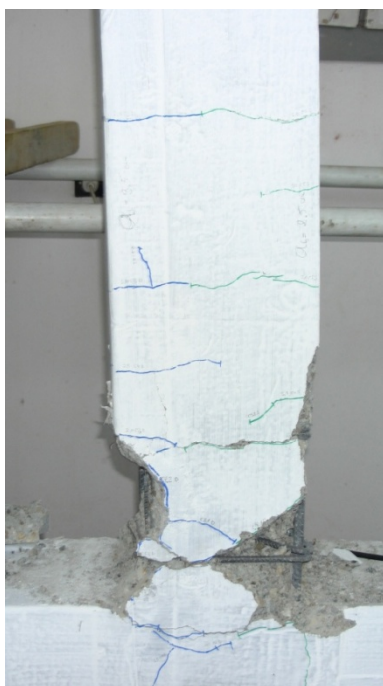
Zone comprimate de beton – formare articulație plastică pentru elementul C1C ( $D1 = 36\text{mm}$ )
